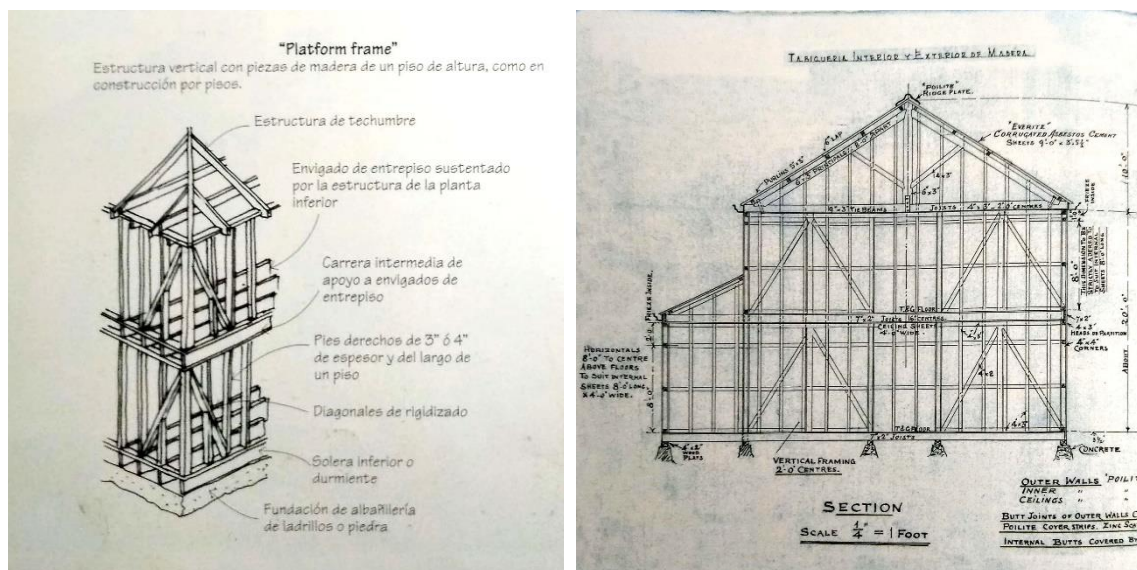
y 27: Sistema Platform Frame y Sección Estructural de vivienda patagónica
